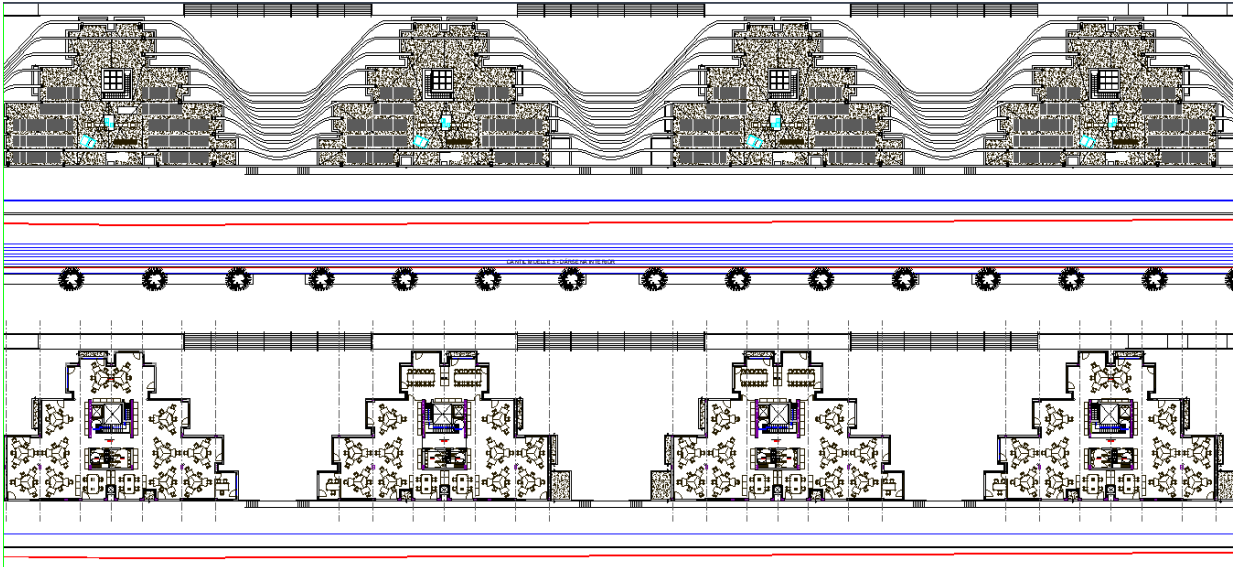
Plantas de uso del edificio, a. Cubierta, b. planta 2ª respectivamente
